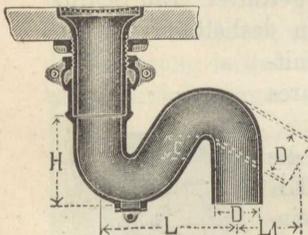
Geruchverschluß mit Befestigungsschelle für Küchenausgüsse aus Stein.
